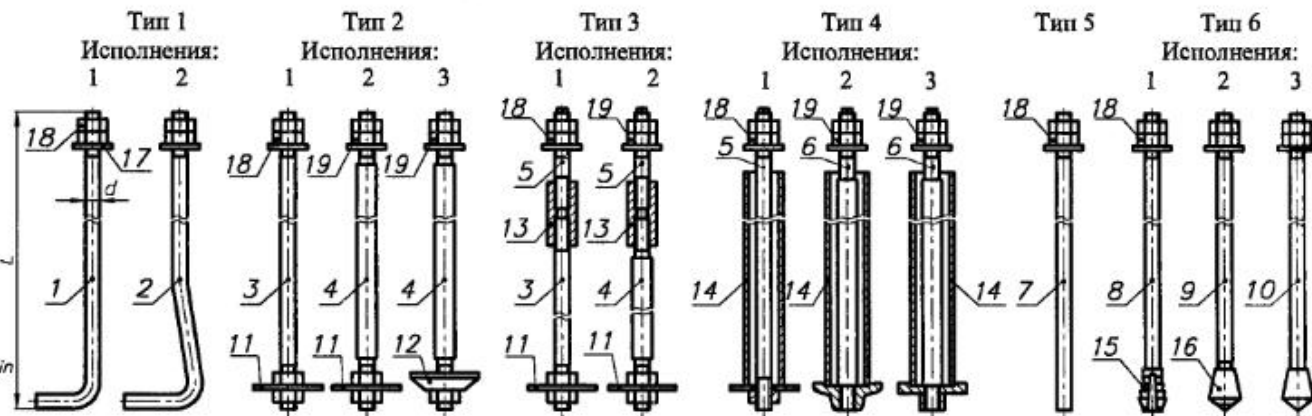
Типы и конструкция фундаментных болтов:
